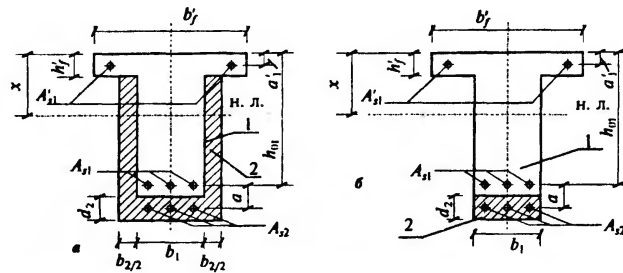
Поперечное сечение балки, усиливается арматурой в растянутой зоне
